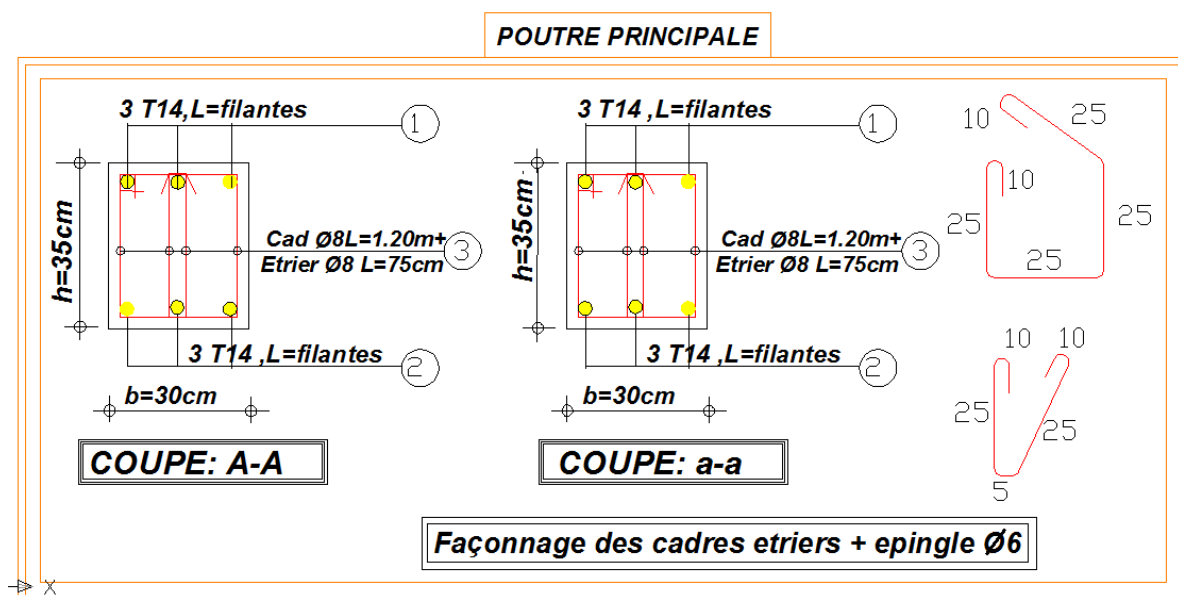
ferrailage des poutres principales de RDC7ème étage
